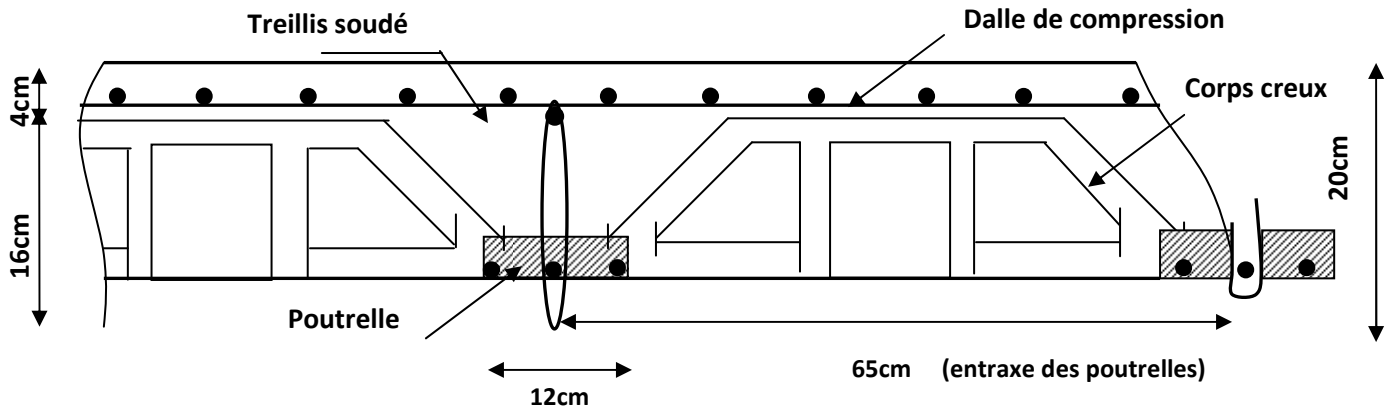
Coupe transversale d'un plancher à corps creux.
